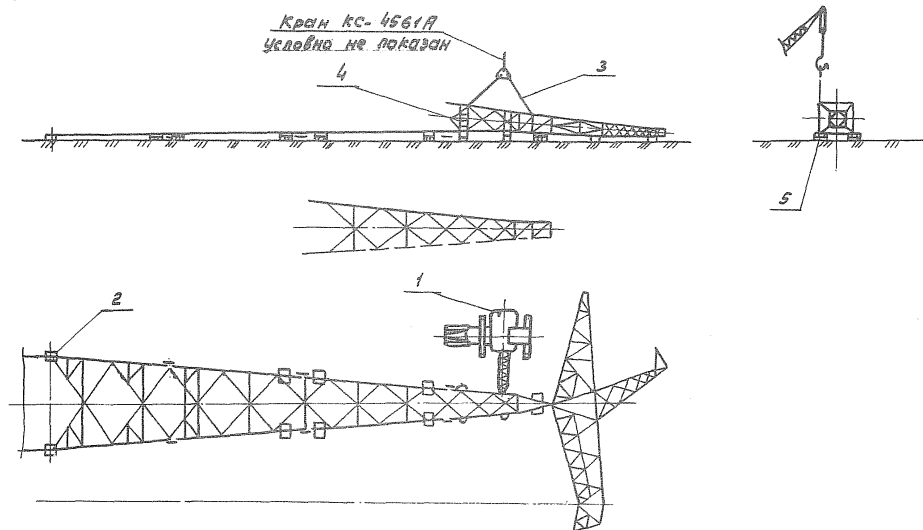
Сборка верхней секции и пристыковка ее к траверсе:
